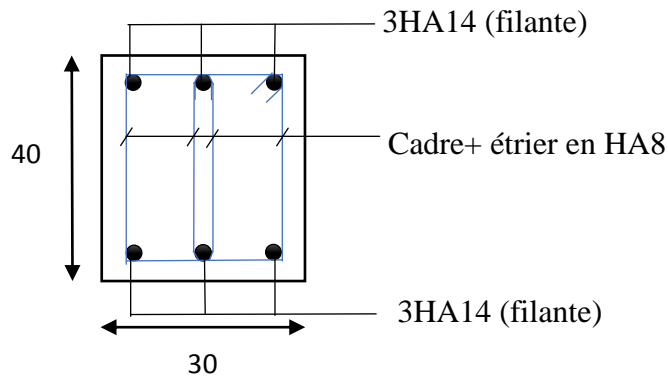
Ferrailage en travée de la poutre principale
